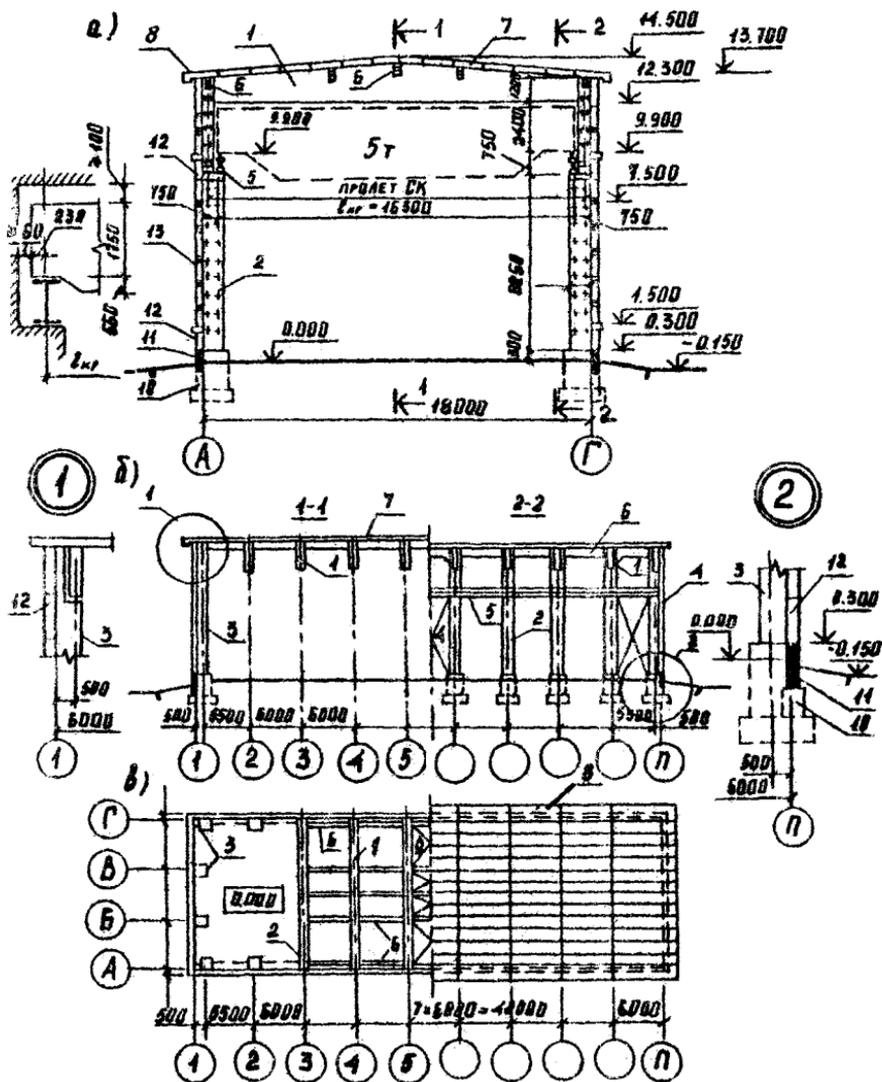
Деревянное одноэтажное здание, оборудованное мостовым краном:
